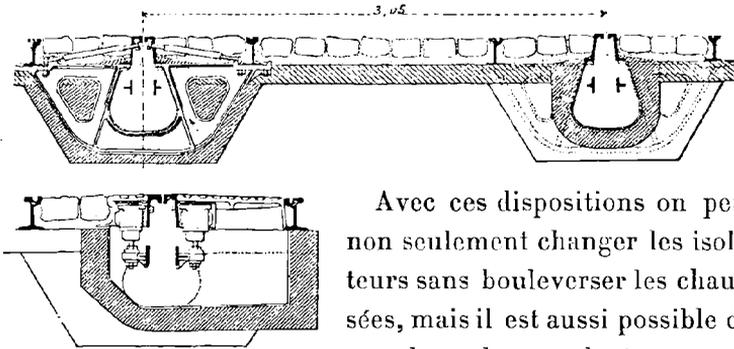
Caniveau système Connett. — Coupe en voie courante et coupe sur regard.
